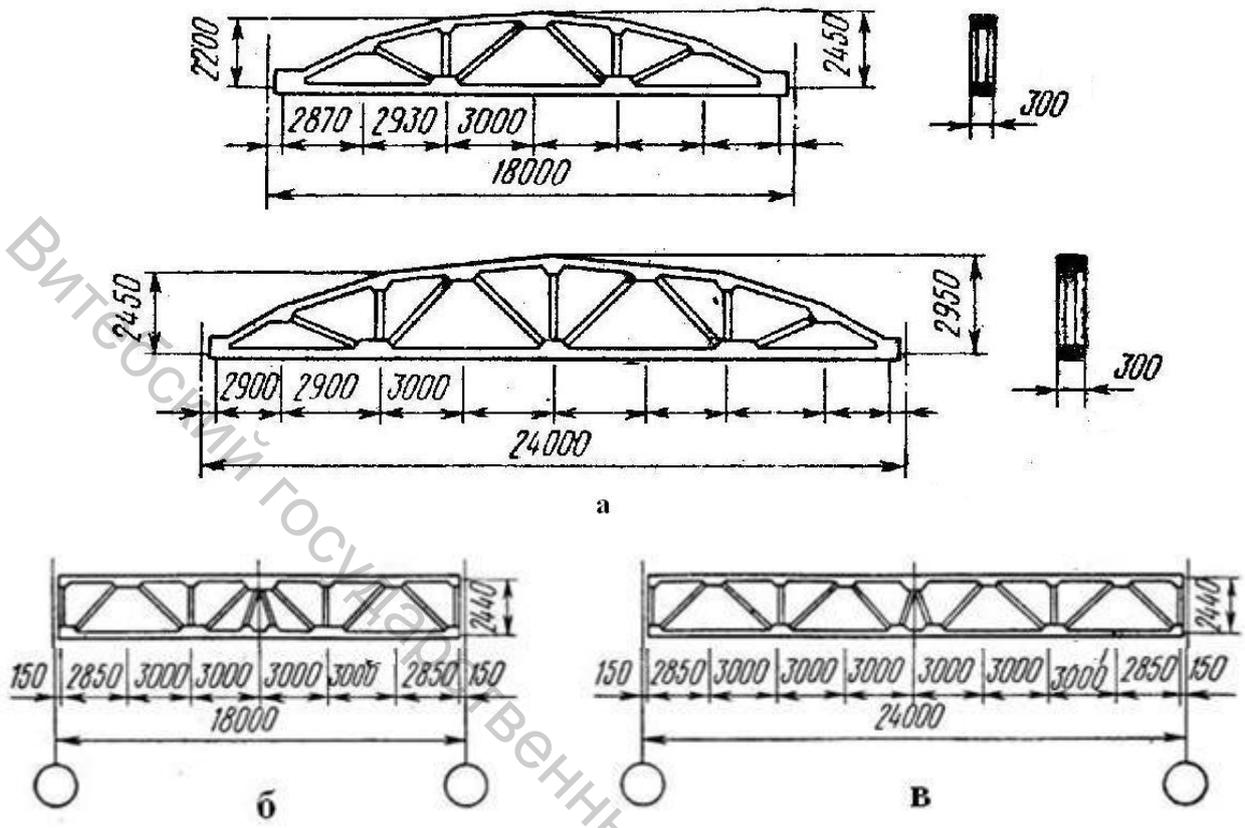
Железобетонные фермы покрытий (а – стропильная сегментная; б – стропильная сегментная с параллельными поясами, длиной 18 м; в – стропильная сегментная с параллельными поясами, длиной 24 м)
